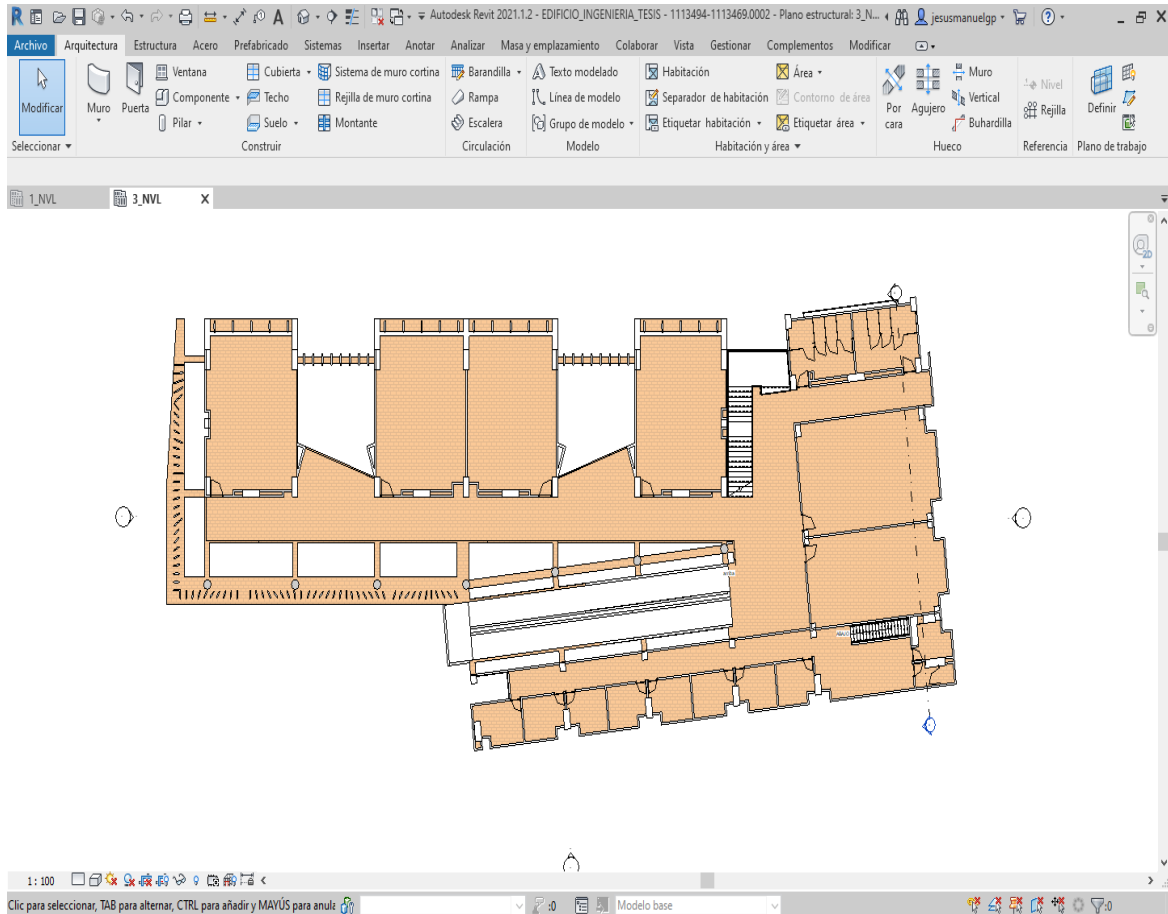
Importación de plano 2D plano estructural planta N°3 edificio aulas oriente.
